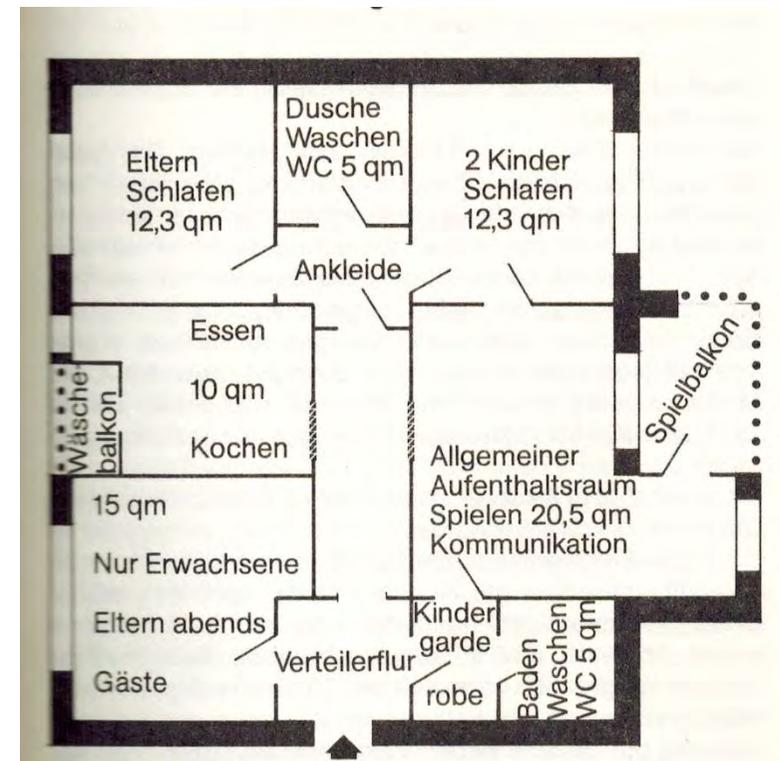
, Demonstrationsgrundriss nach Dessai[6]
